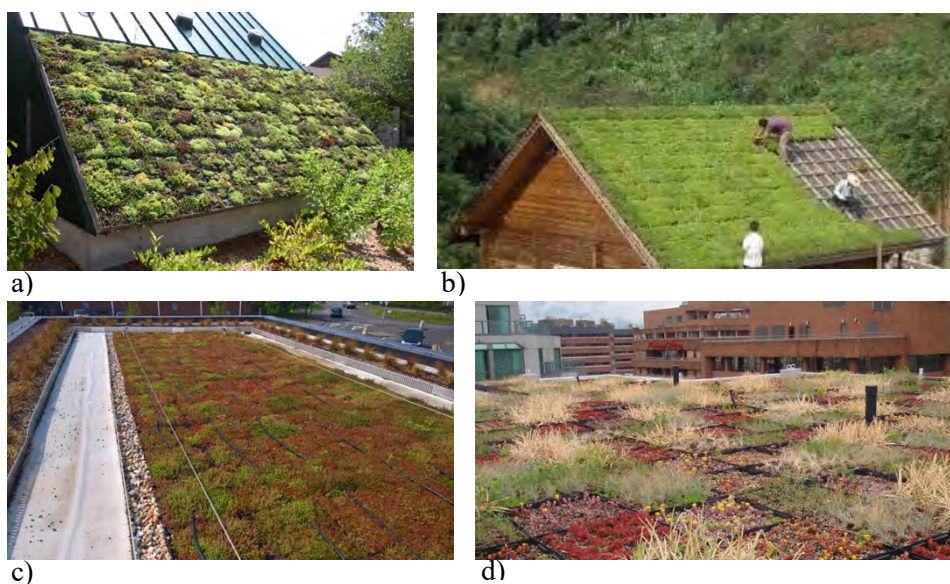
Exemplos de aplicação do sistema modular de cobertura verde: a) e b) Aplicação em cobertura inclinada; c) e d) Aplicação em cobertura plana (Fonte: *Canadian Contractor, Greening Solutions, Wallbarn, Tounesol Siteworks*).
